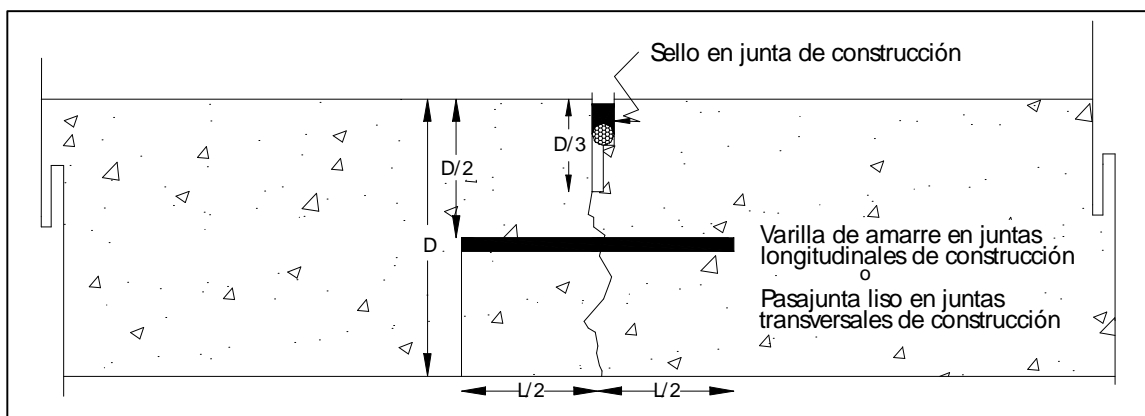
Sellado para juntas del pavimento de concreto hidráulico.
